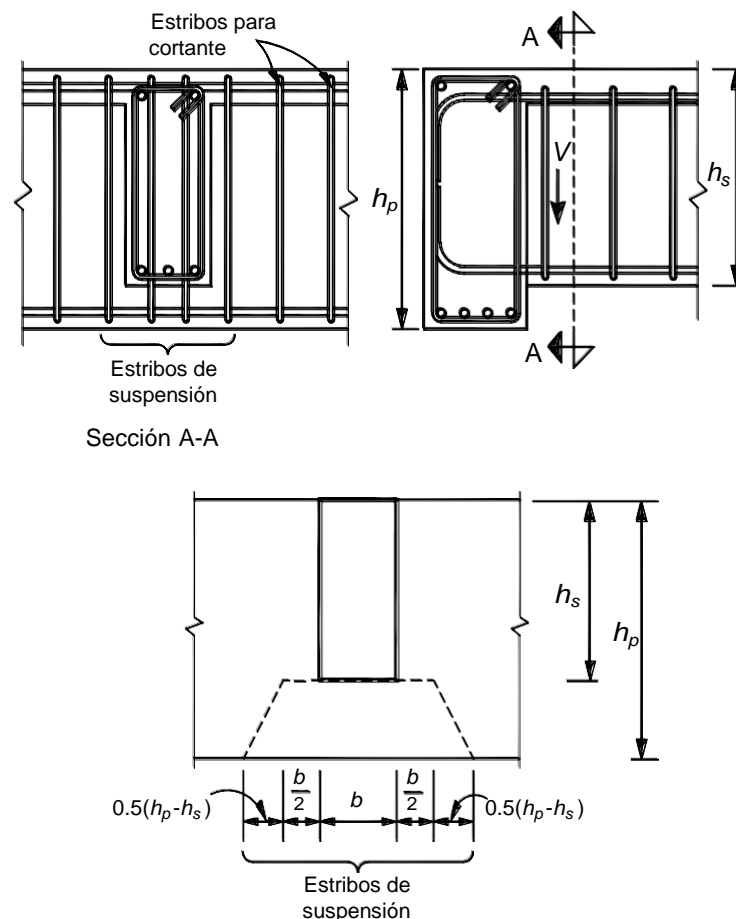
Transmisión de fuerzas y conexión entre vigas secundarias y principales
